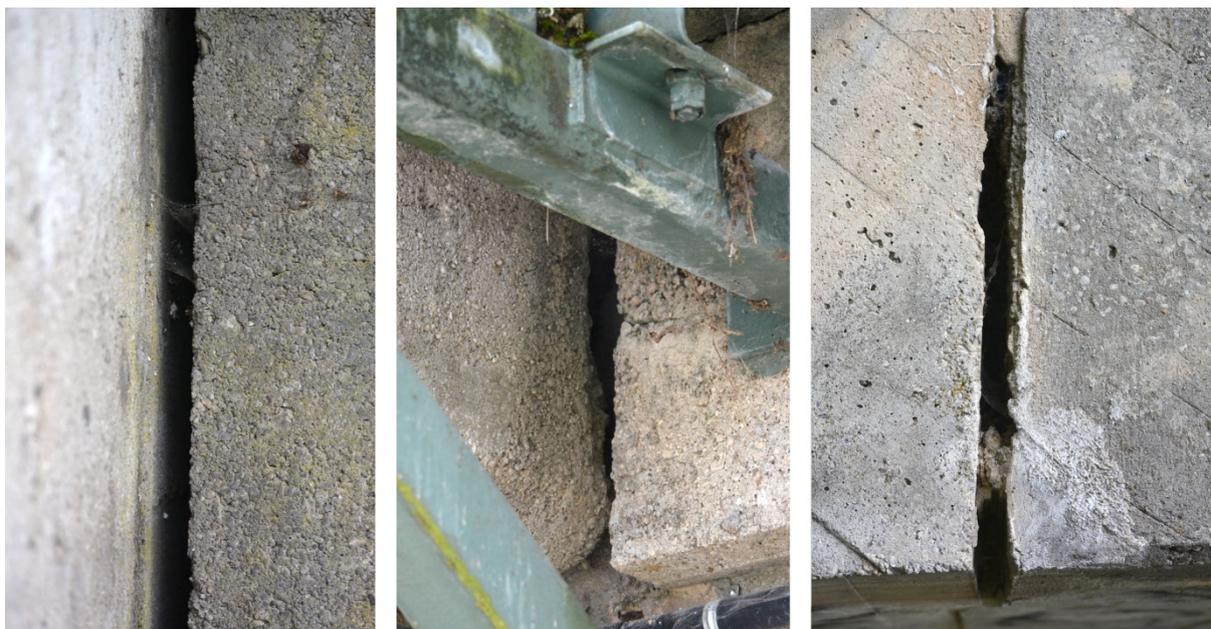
Eisenbahnbrücke: Typische vertikale Spalten im Mauerwerk der Brücke (links & mitte: Ecklage, rechts: Bruchstelle in einem Gewölbebogen), teilweise mit Spinnweben verhängen. Tagesversteck möglich.
